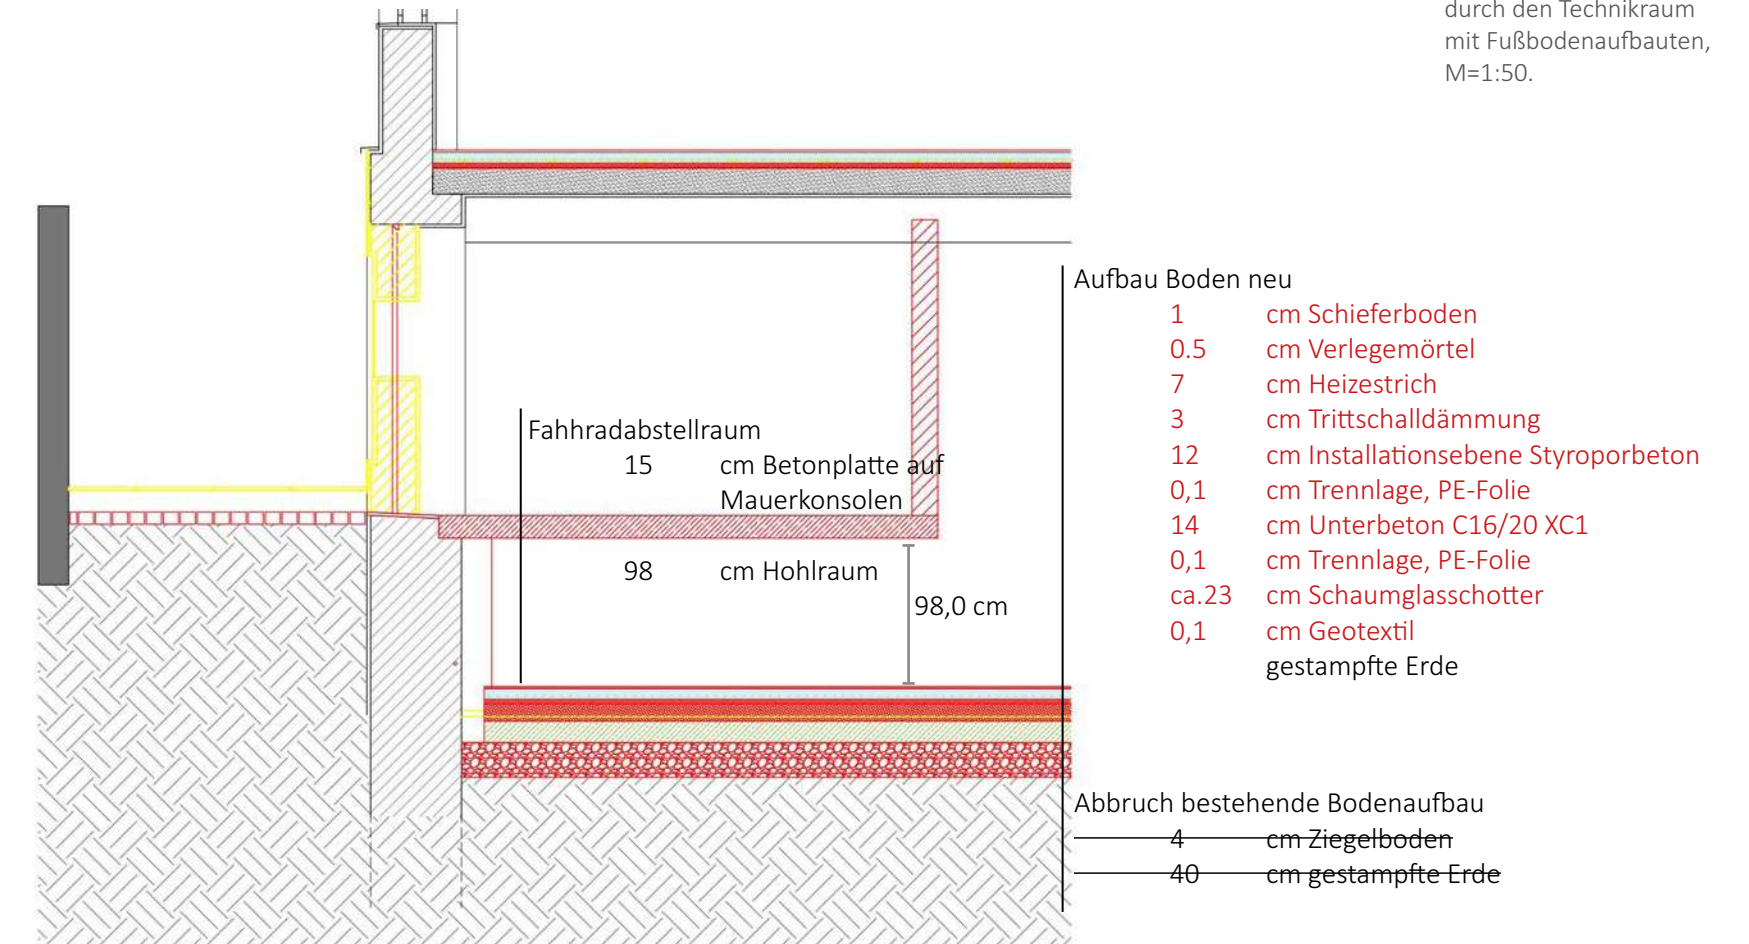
Detailschnitt durch den Technikraum mit Fußbodenaufbauten, M=1:50.
